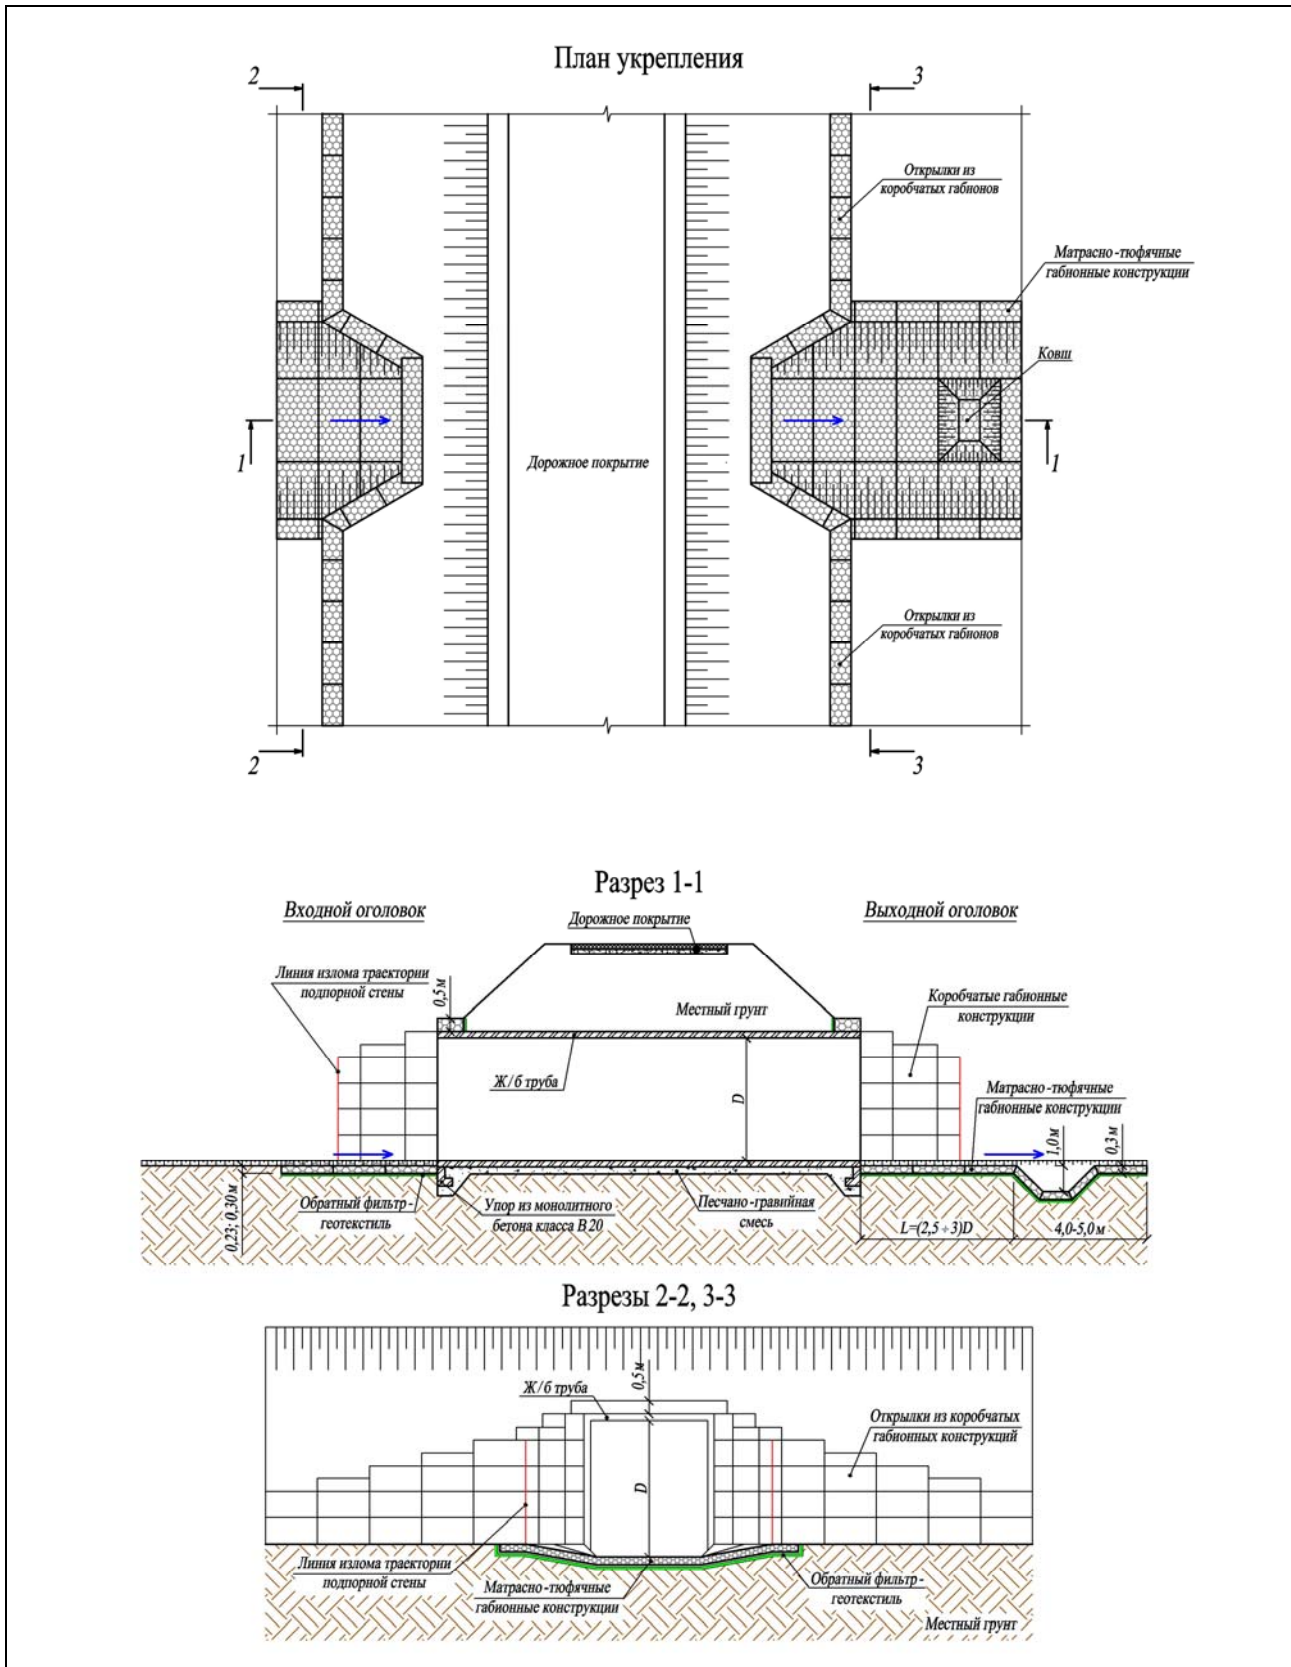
Укрепление оголовков водопропускной трубы открылками из габрионных конструкций
